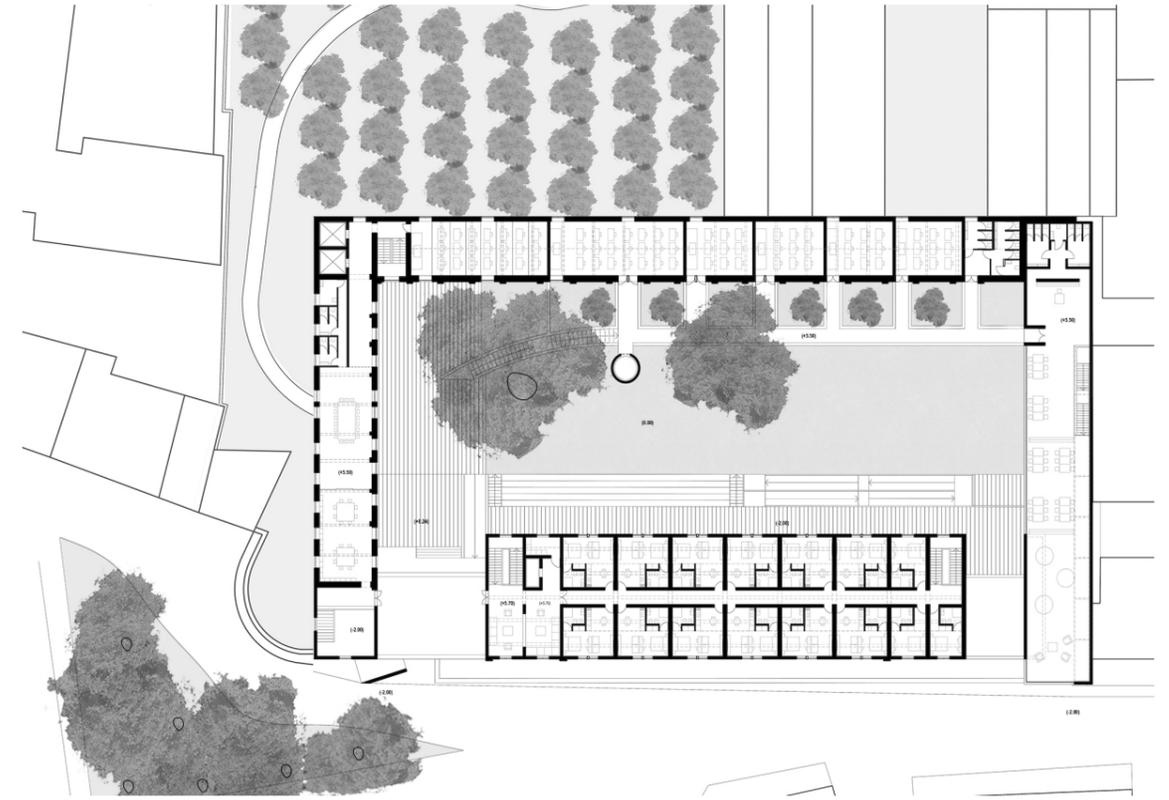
I ipotesi di progetto - Pianta I piano Palazzina Vespi. (Raimondi G., Montevago E., Salamone C.).
